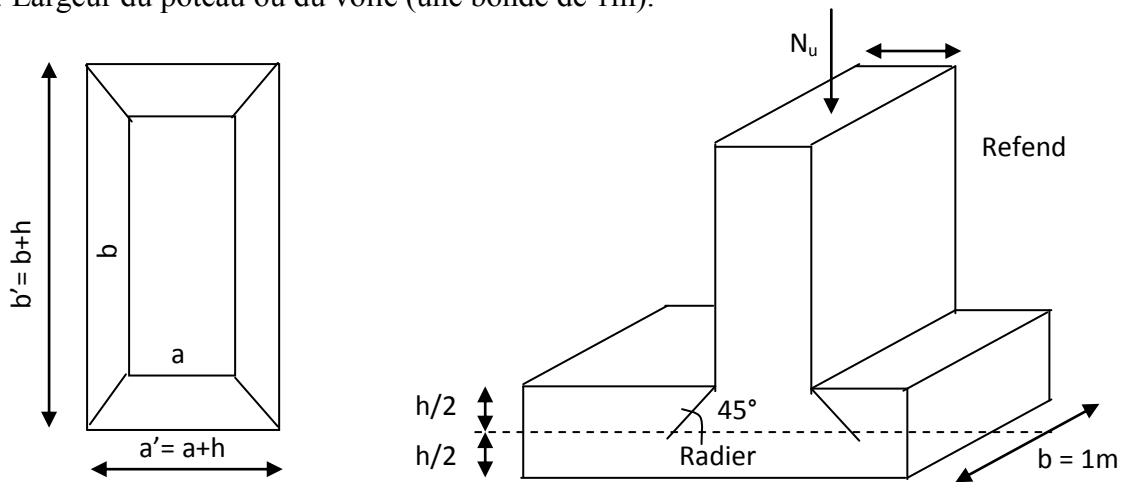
Périmètre utile des voiles et des poteaux.
